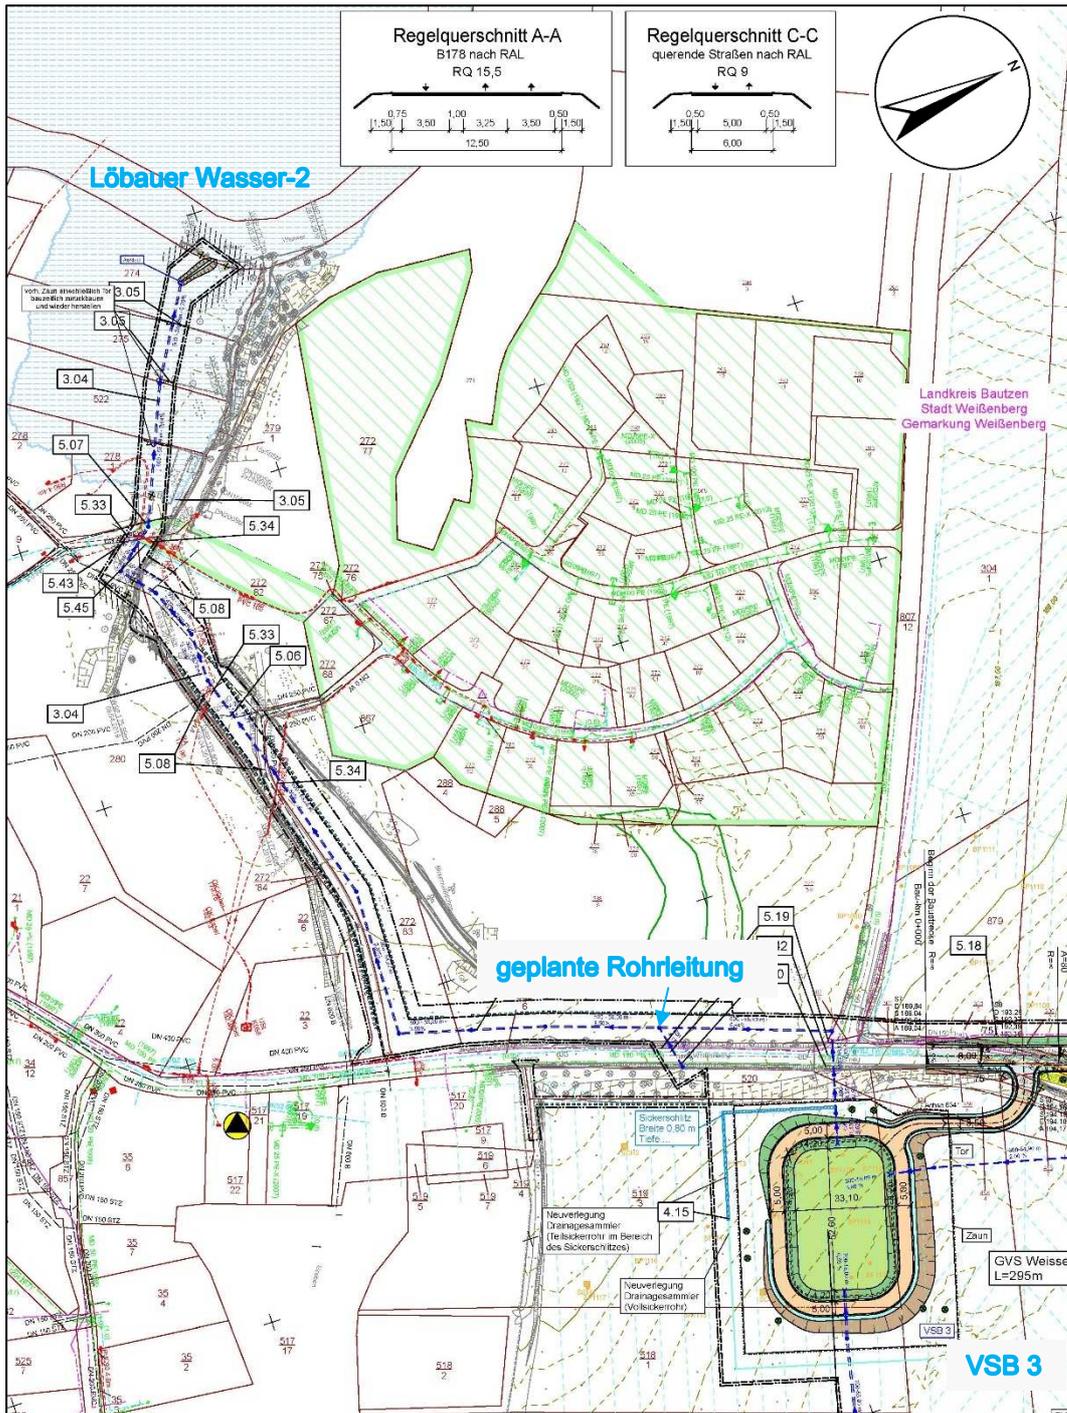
Drainiertes Versickerungsbecken 3 mit geplanter Leitung mit der Rohrleitung zum Löbauer Wasser (Quelle: Unterlage 5, Blatt 7)
